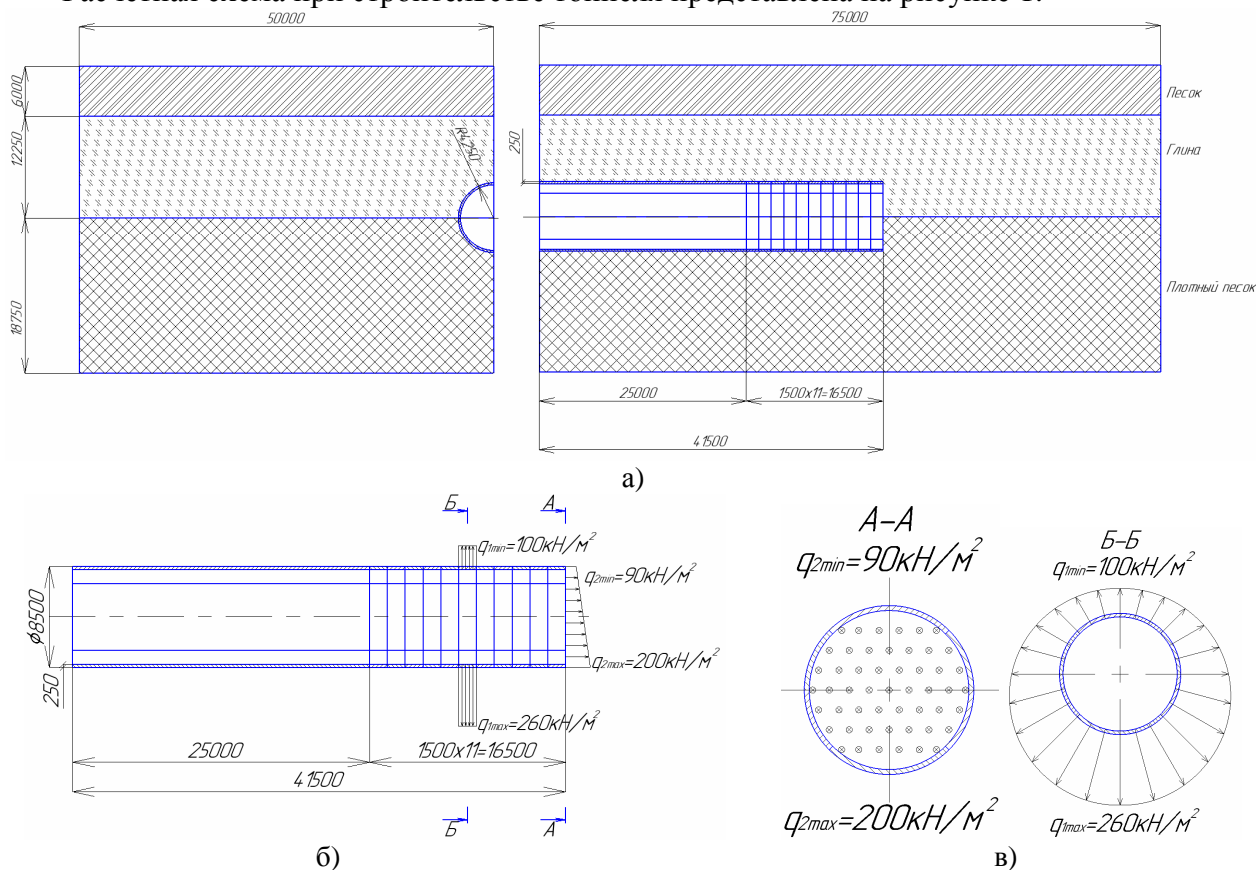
а) пространственное расположение тоннеля в грунтовом массиве; б) расчетная схема тоннеля; в) разрез А-А с указанным на нем давлением грунтопригруза на забое, разрез Б-Б с указанным на нем давлением тампонажа
